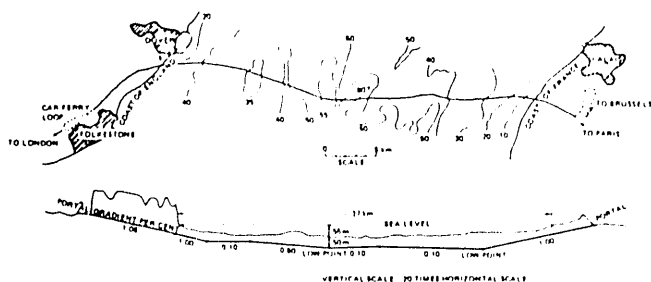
Túnel de la Mancha. Planta y perfil longitudinal.
